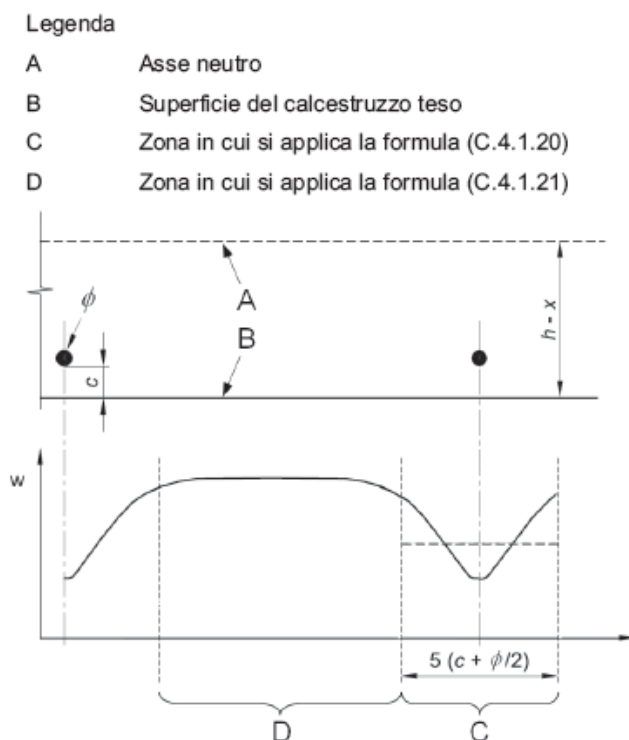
Ampiezza delle fessure, w , in funzione della posizione rispetto alle barre di armatura.
